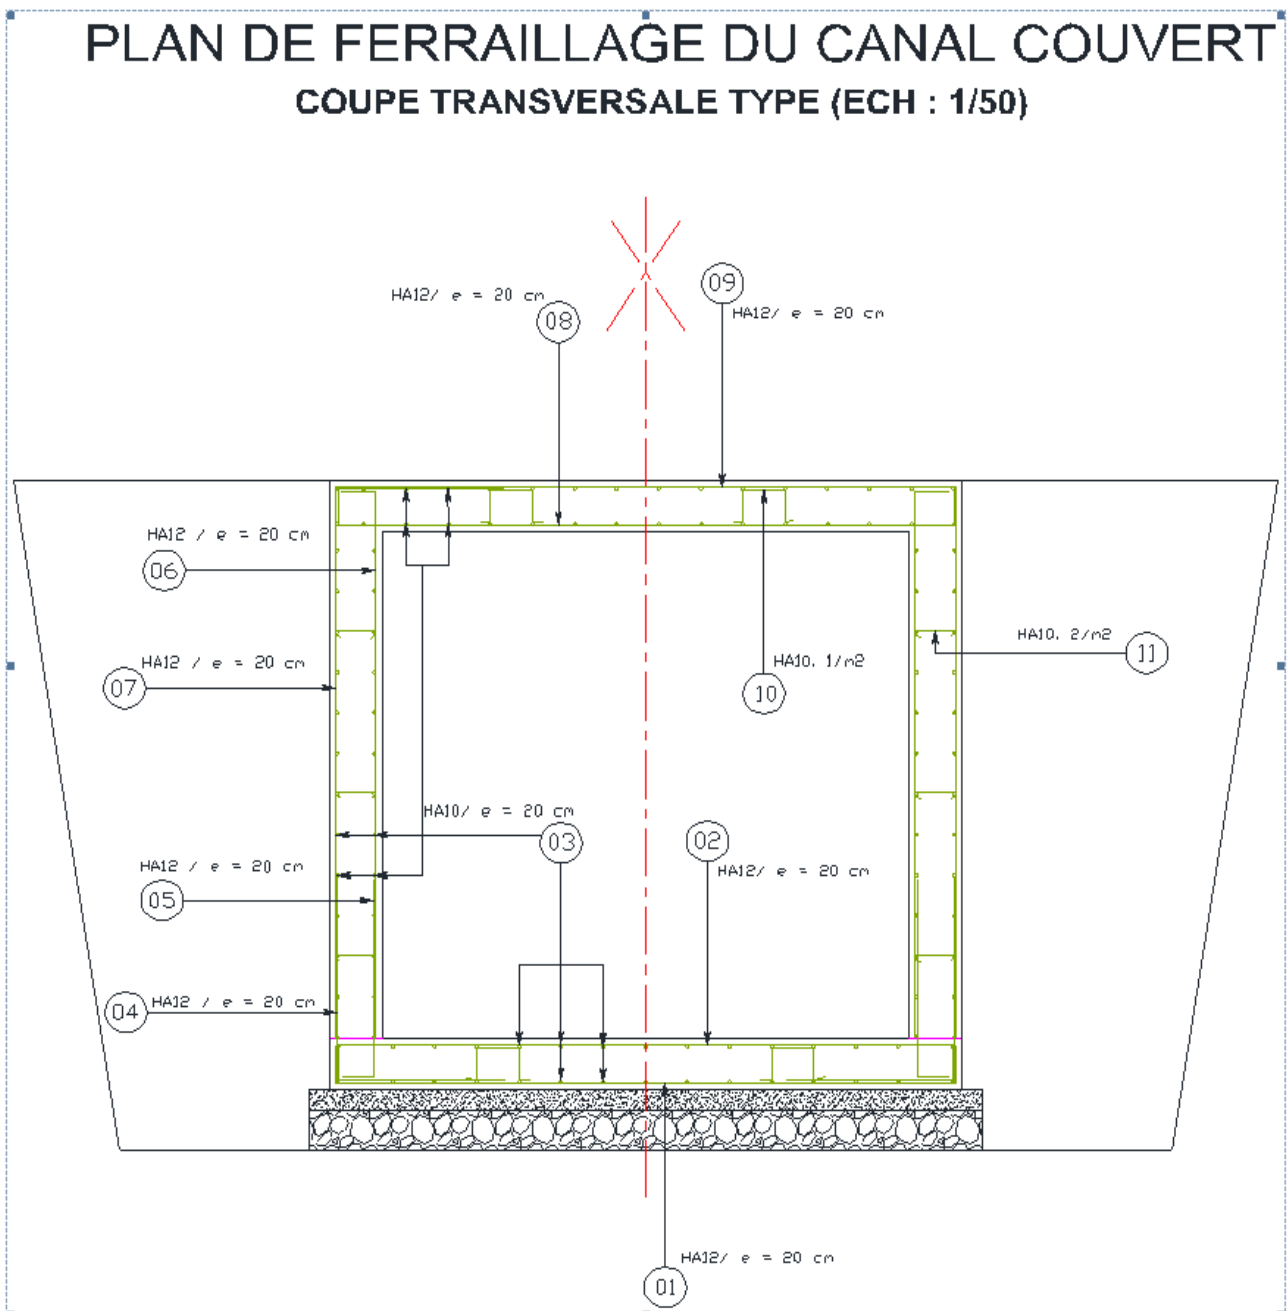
ferrailage (hauteur de recouvrement de 0.5 à 1 m
